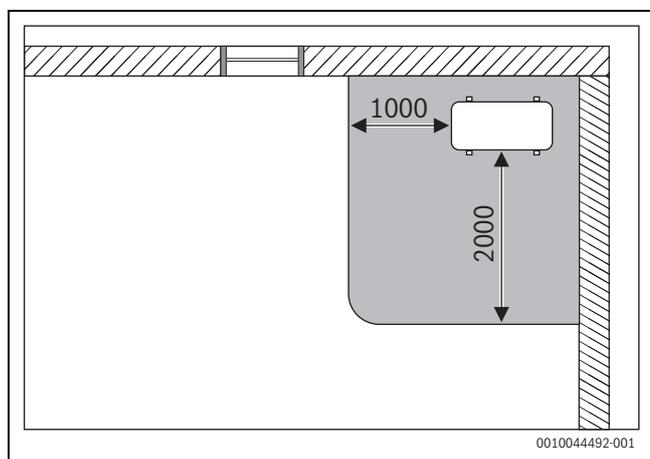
Área de proteção, unidade exterior de chão num canto (dimensões em mm)
